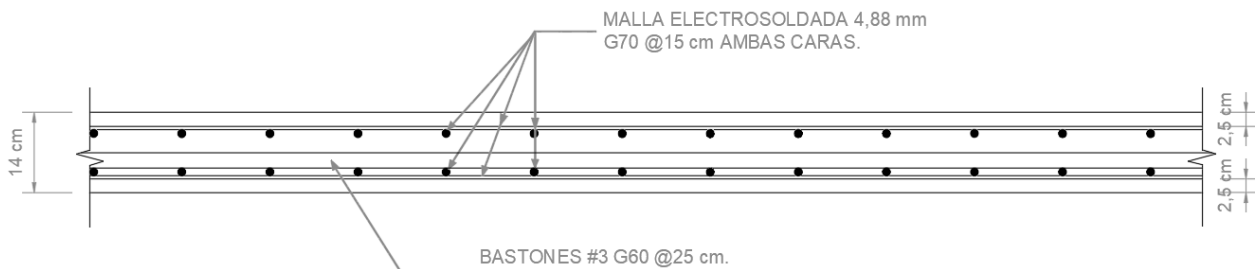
Sección transversal del eje longitudinal de la losa vista en campo (bastones para momentos positivos)
